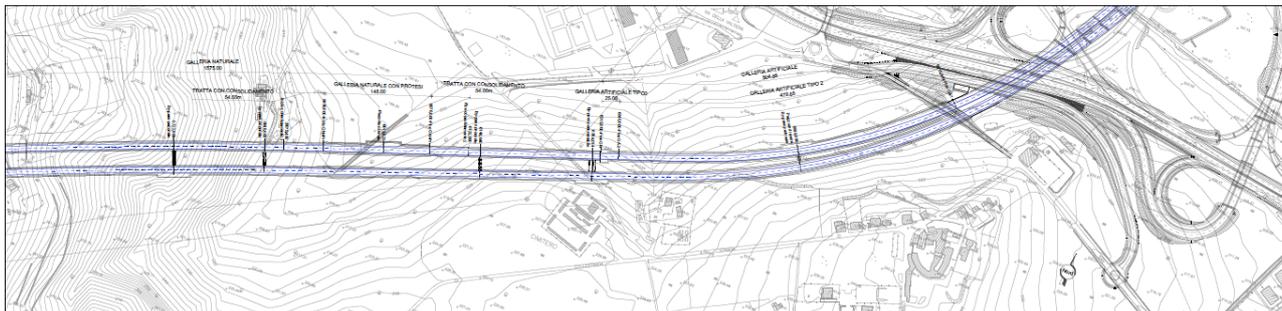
Stralcio planimetrico della galleria con vista su imbocco nord
